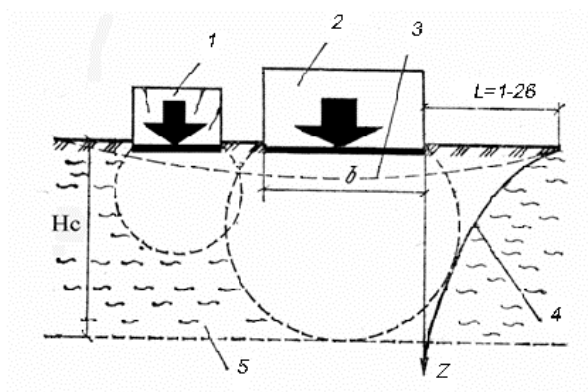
Осад поверхні ґрунту: 1 – існуюча будівля; 2 – будівля що зводиться; 3 – зона осадки; 4 – епюра осадки; 5 – сильно стиснутий ґрунт
